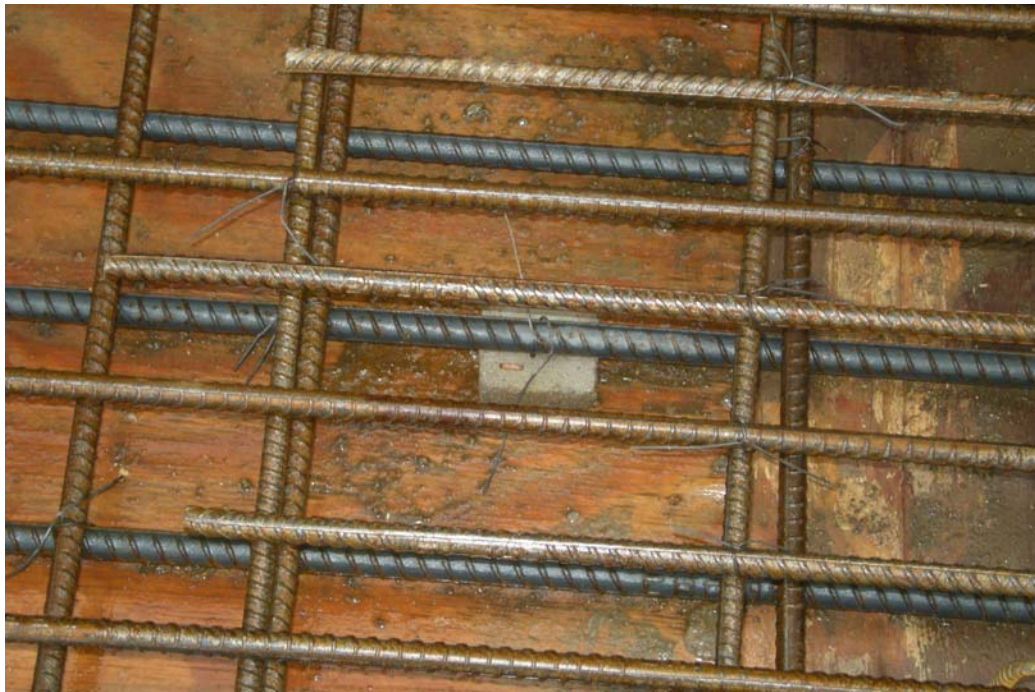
Recubrimiento Armadura Inferior con Caluga de 2,5 cm. Este recubrimiento siempre se cumple. En algunas zonas existe problema con el recubrimiento superior, debido a que hay zonas donde la losa producto de la contraflecha de viga, quedo de aproximadamente 21 cm.
